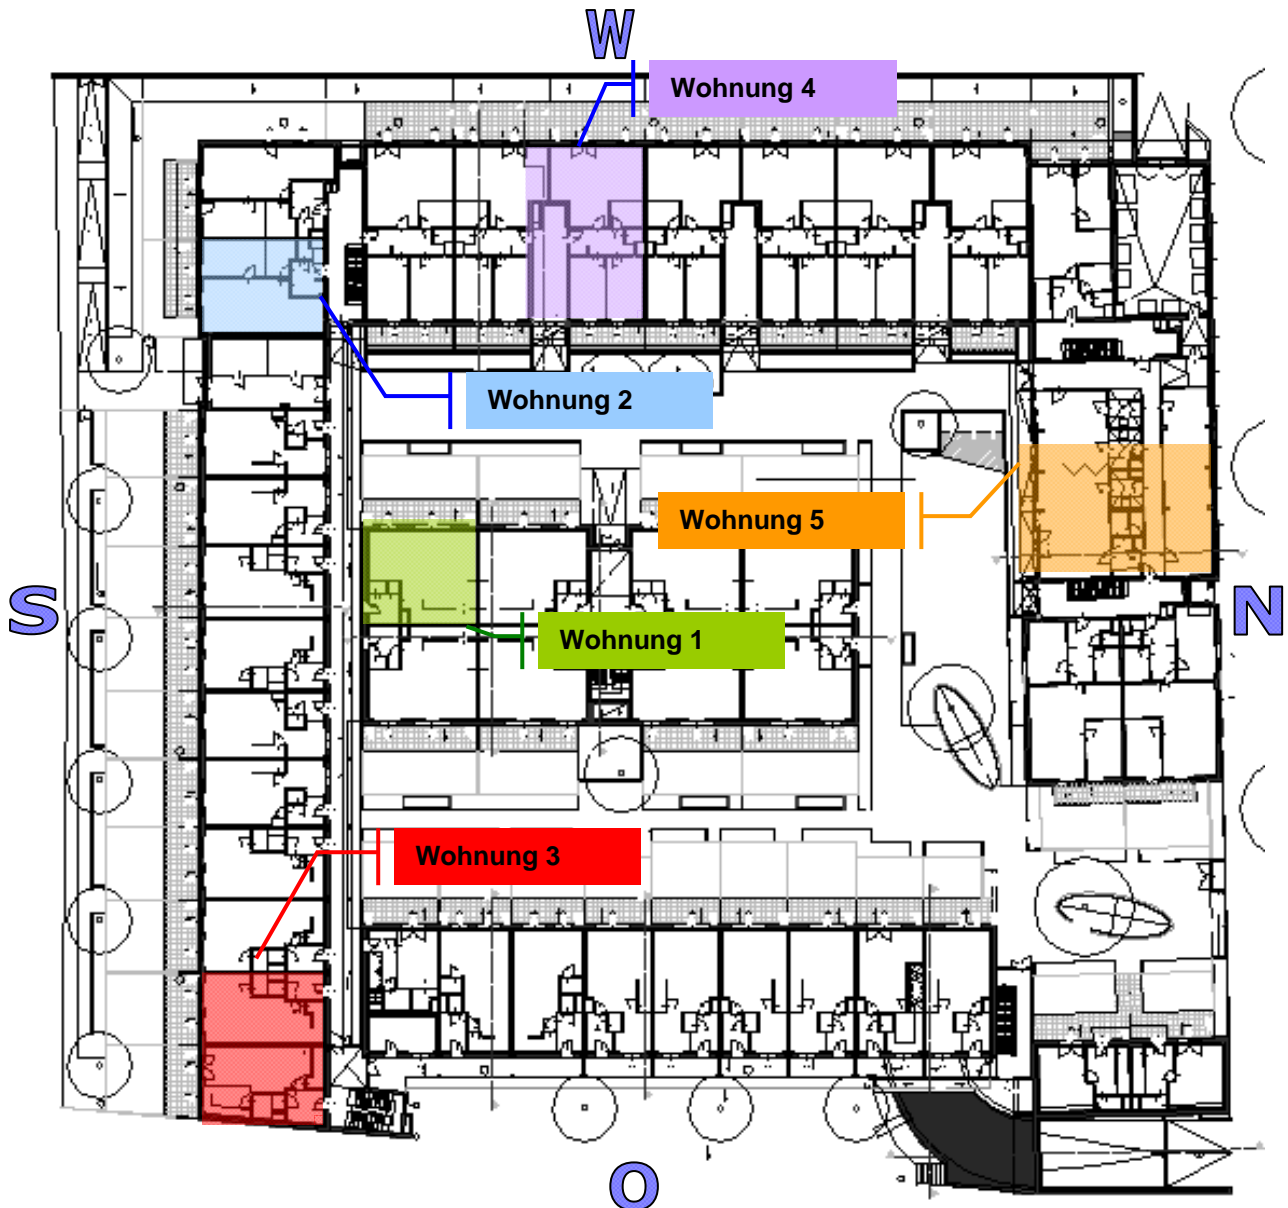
Regelgeschossgrundriss mit Lage der fünf Messwohnungen
